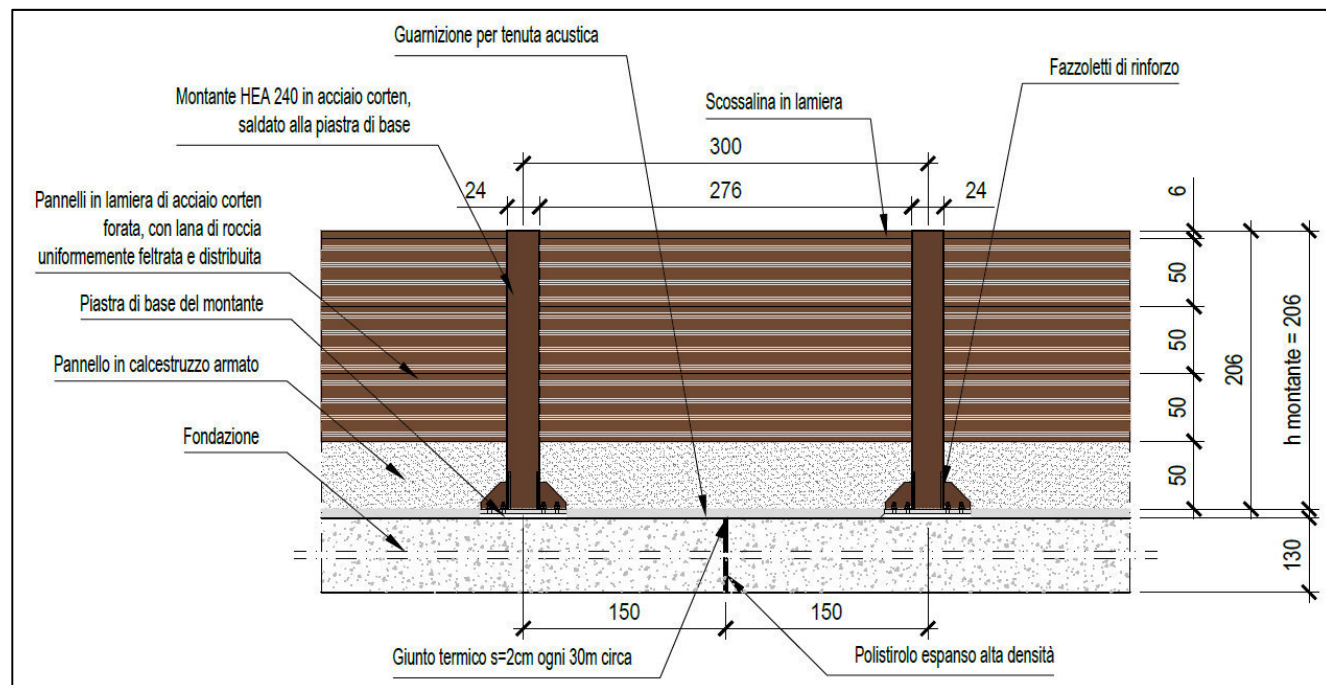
Prospetto delle barriere opache in corten da 2 metri
